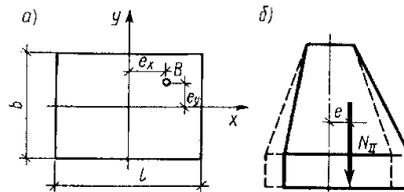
Внецентренное нагружение фундамента относительно двух главных осей инерции:
